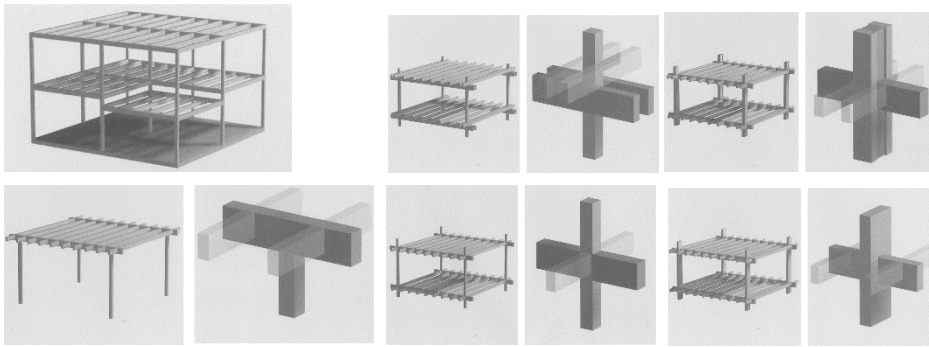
Alternativas de ligação dos pilares com as vigas (Kolb, 2008) .
